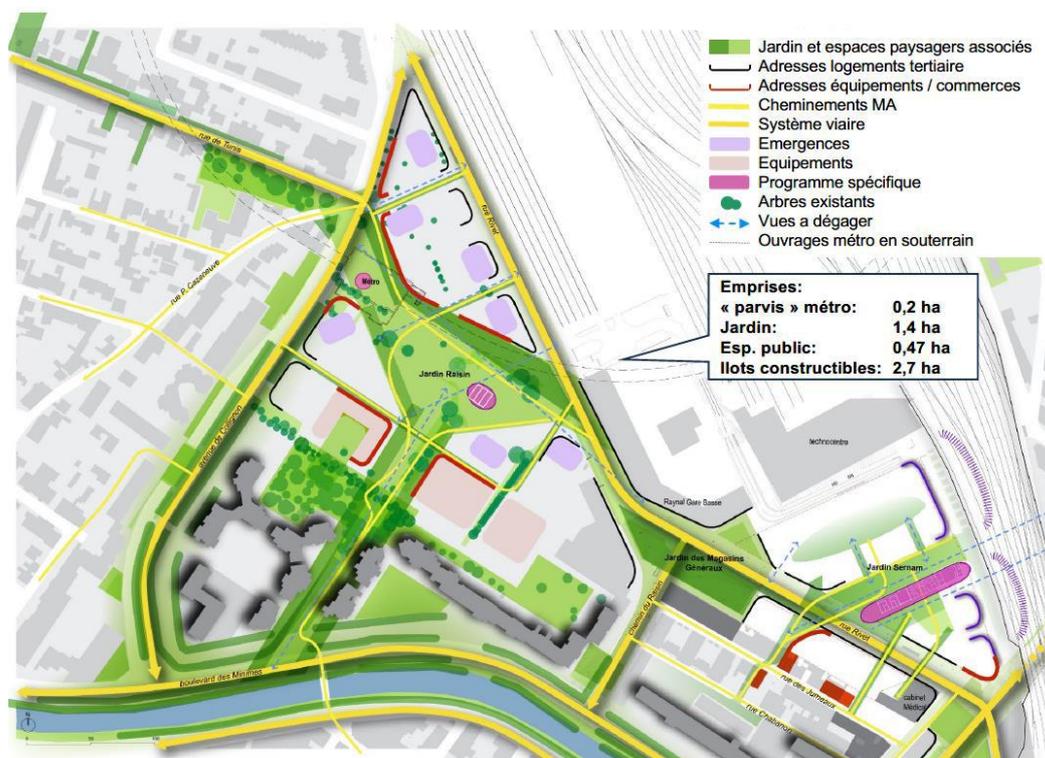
nouveau plan de masse du quartier Raisin (source : dossier).
